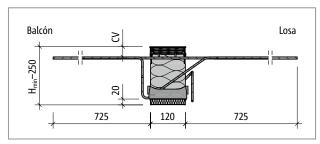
Schöck Isokorb® XT tipo K-M7 hasta M9: Sección del producto
